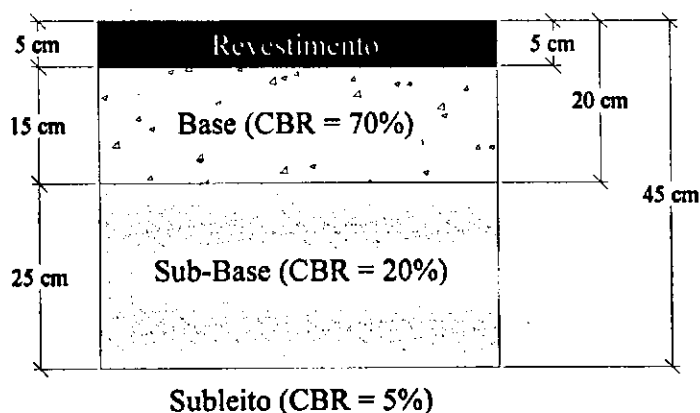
Espessuras das camadas de um pavimento dimensionado pelo método do CBR
